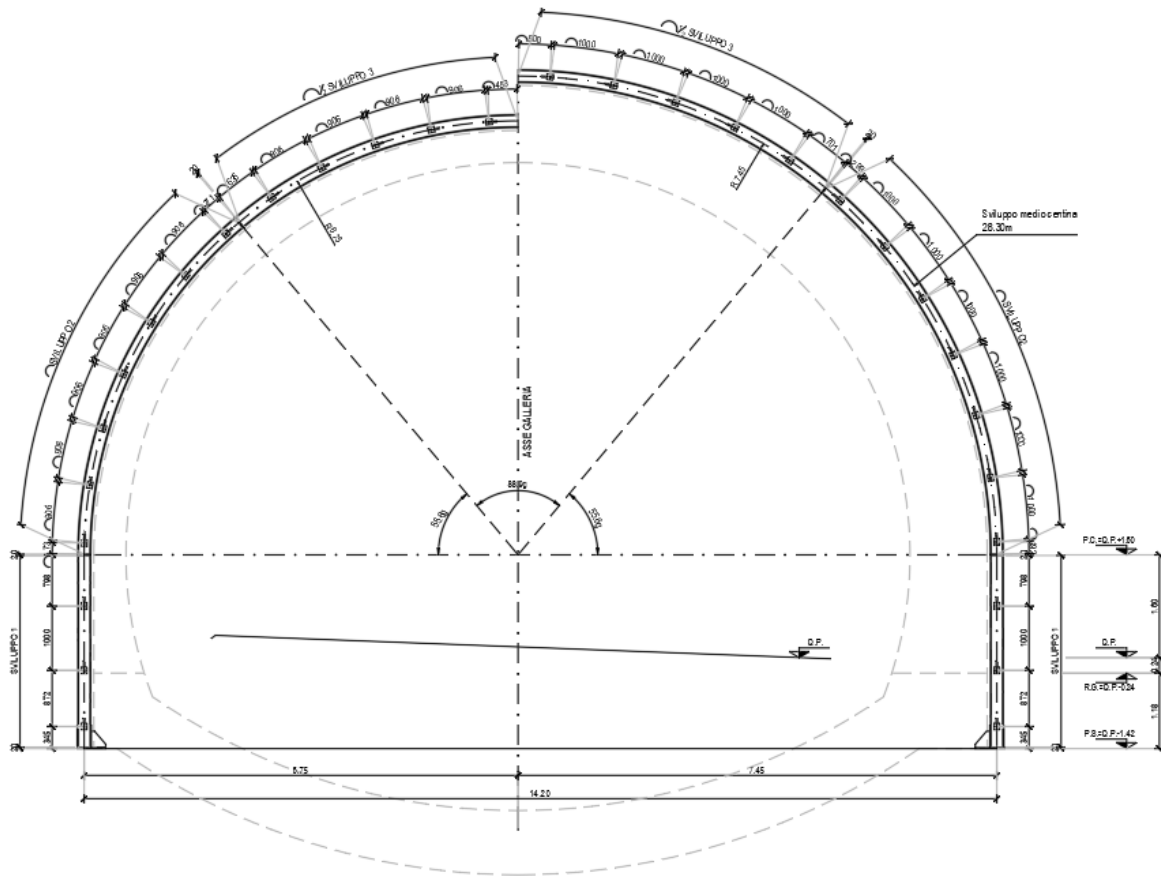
Sezione tipo B2v – Infilaggi metallici
